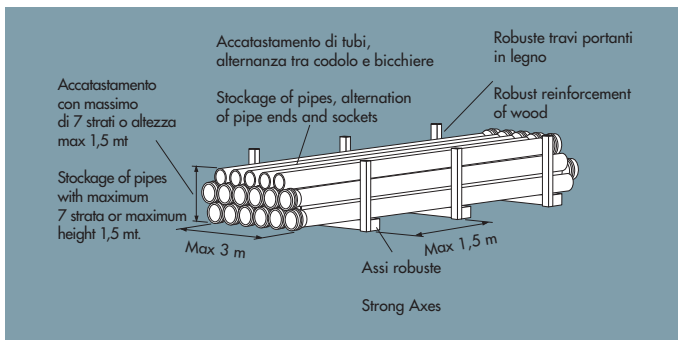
Stoccaggio dei tubi in cantiere - Staking of pipes on the building yard
